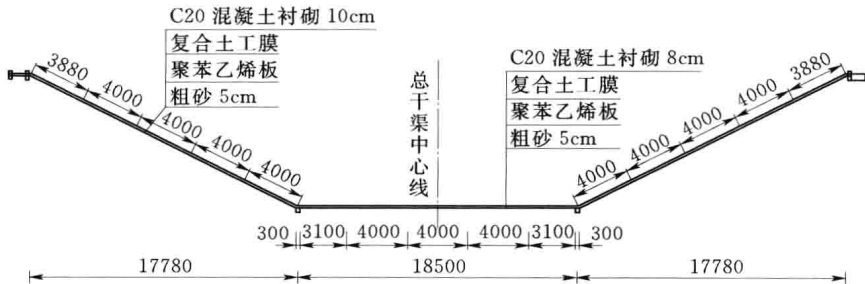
南水北调工程渠道典型断面图(单位: mm)
